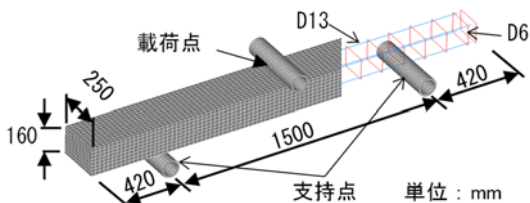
鉄筋コンクリート梁の3点曲げの解析モデル
